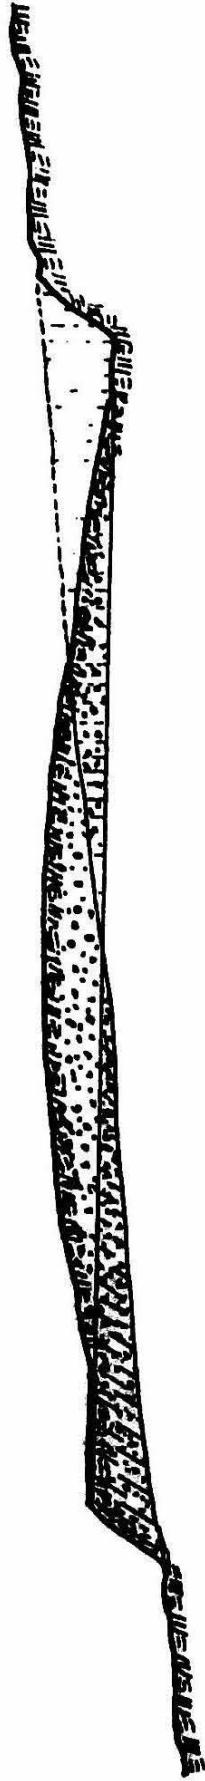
Movimentação de terra para construção de curral em terreno inclinado.
